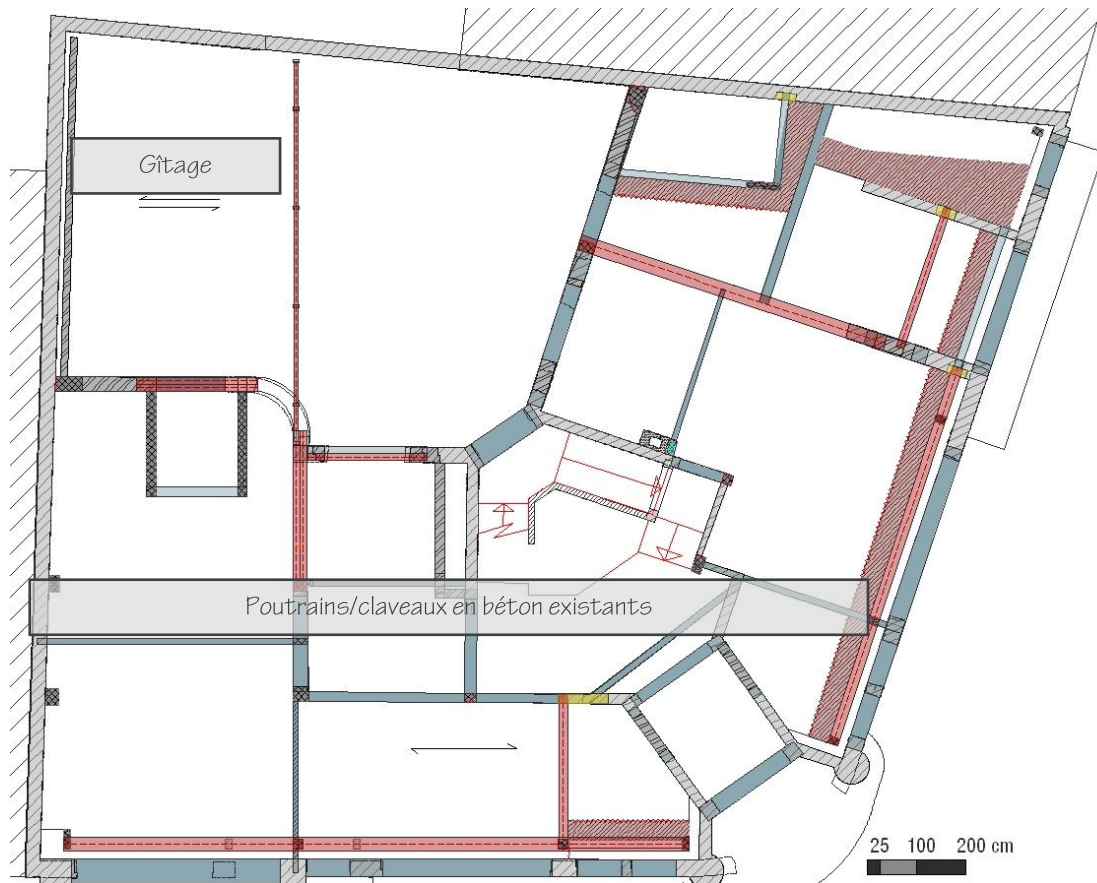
Plan de stabilité, haut rez-de-chaussée (Source: Bureau JZH & Partners, 2010)
